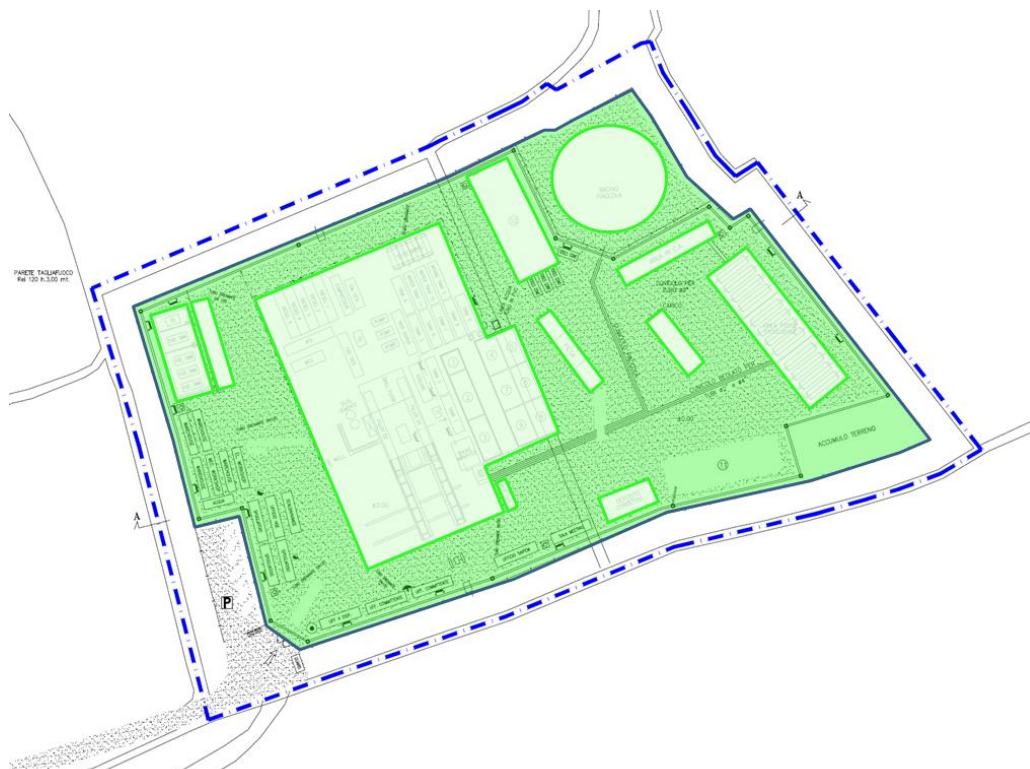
Individuazione delle aree interne alla postazione caratterizzate dalla presenza di telo impermeabile
